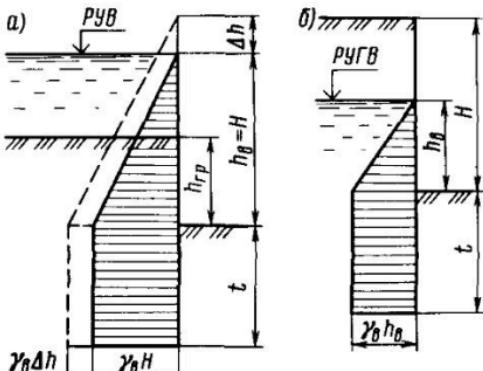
Расчетная эпюра гидростатического давления в несвязанных грунтах:
